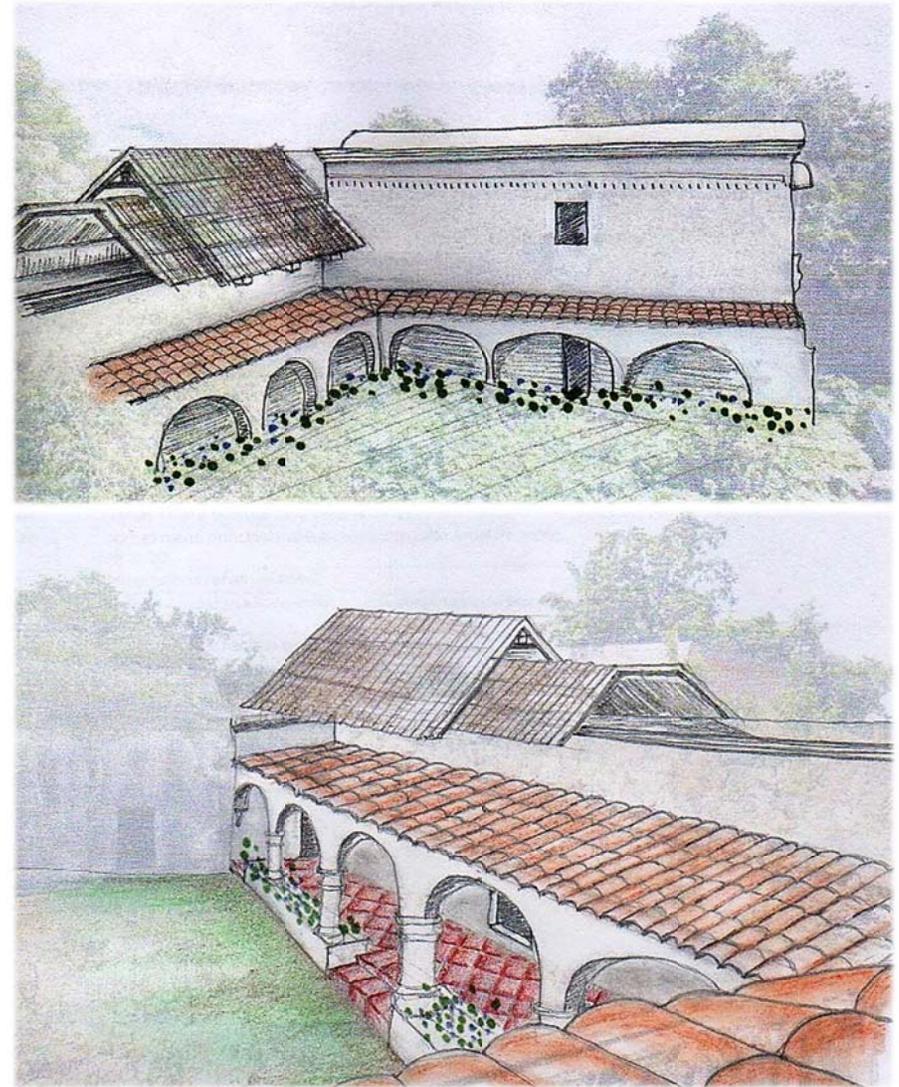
Se observan: la cubierta de tejamanil, pasillos cubiertos de teja y pavimentos de barro. Perspectivas de hipótesis de imagen original de la Hacienda.
